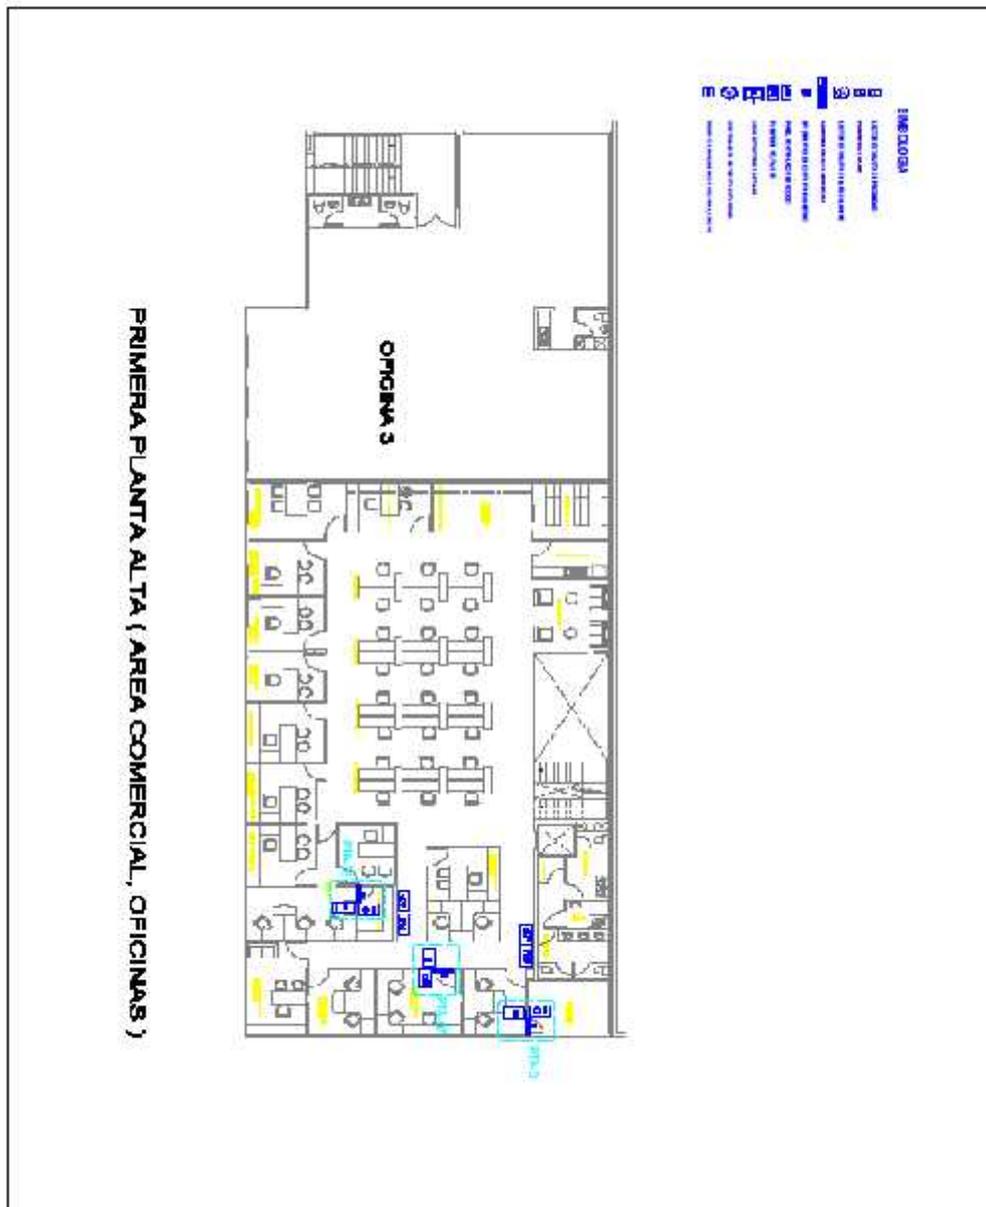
Control de Acceso a la Primera Planta Alta del área comercial
